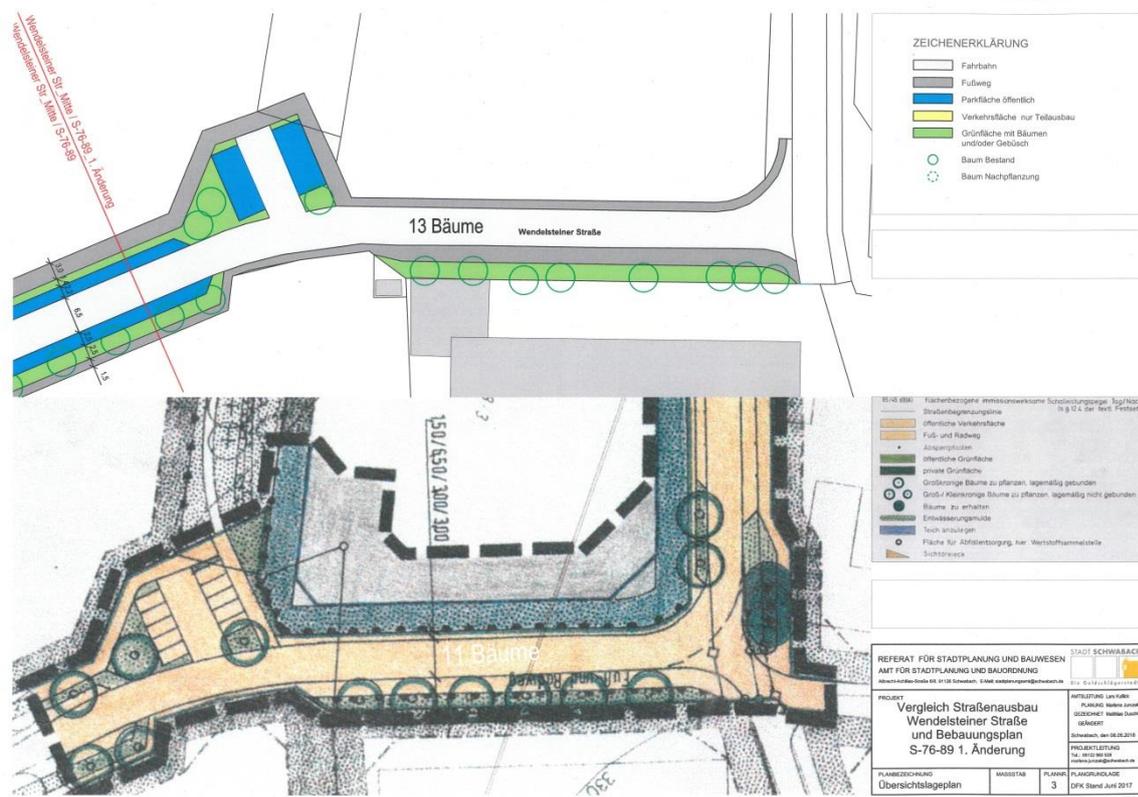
Bebauungsplanausschnitt S-76-89 - Bereich: Wendelsteiner Straße
